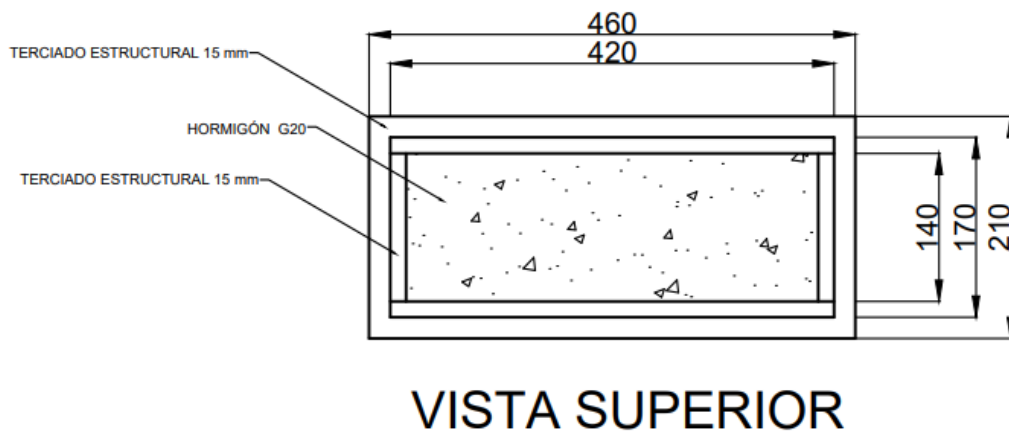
Diseño moldaje del bloque con eco-ladrillo, vista superior.
